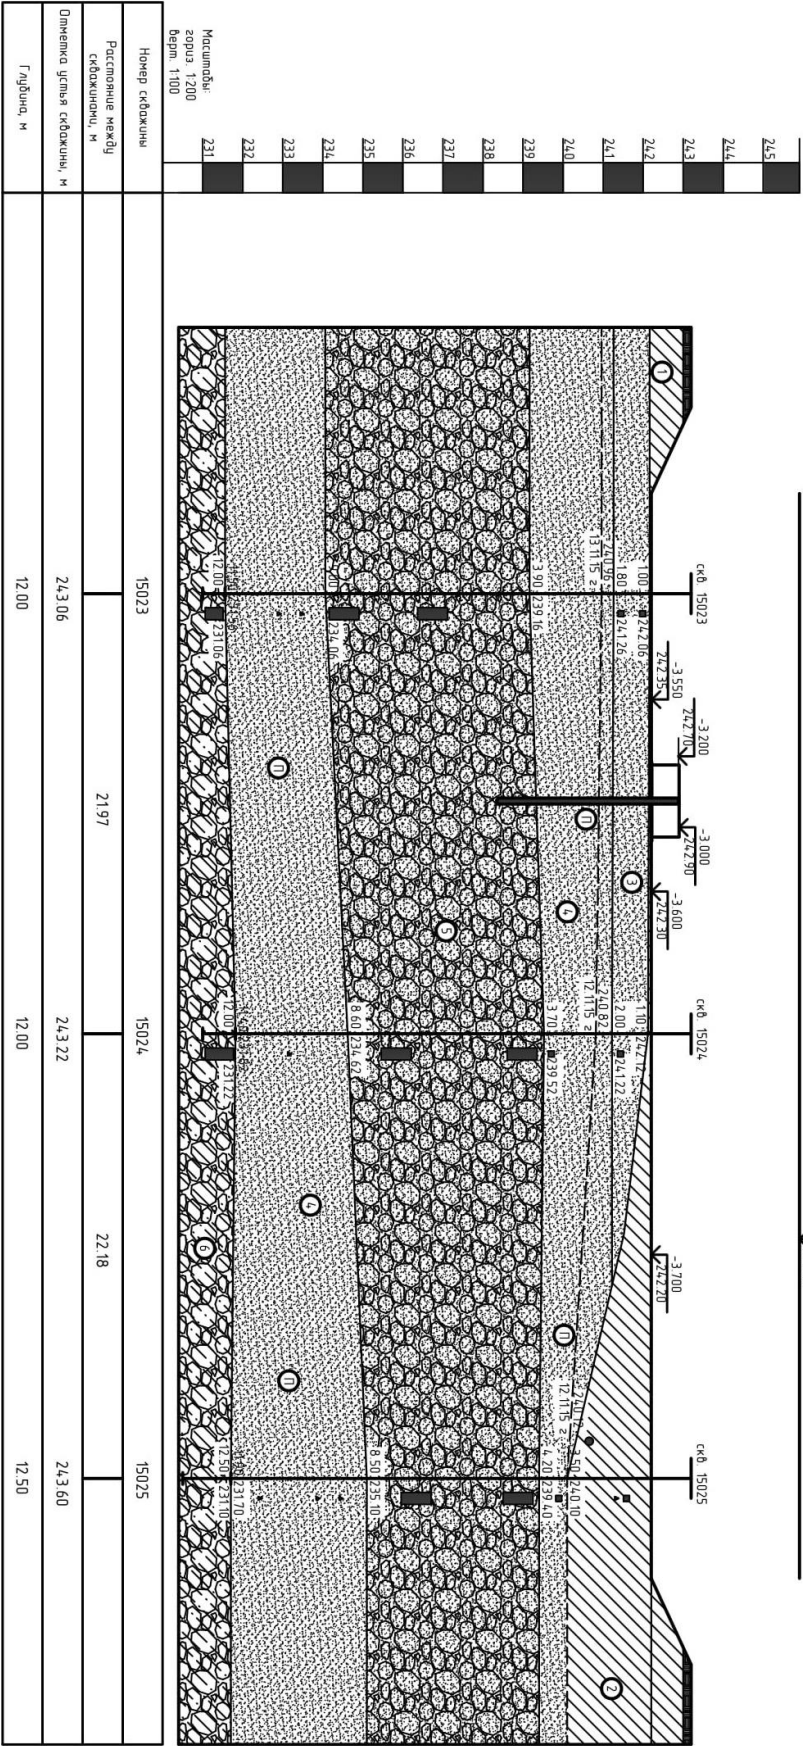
Геологический разрез со строительной площадки I–I
